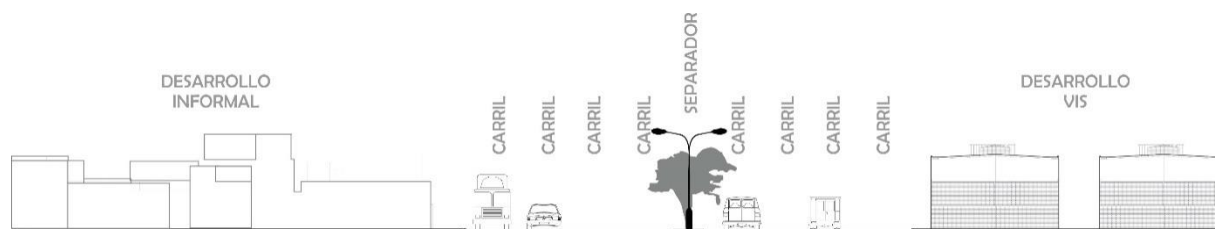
Perfil vial proyectado Av. 1 de mayo. Fuente: Elaboración propia CC-BY-NC-ND
